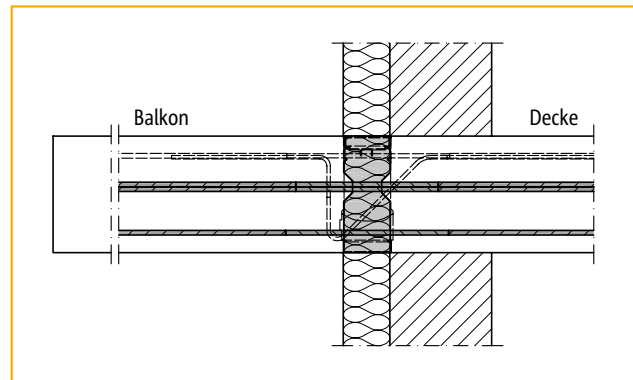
Mauerwerk mit Außendämmung bei deckengleichem Balkon + Typ K + Typ EQ1
